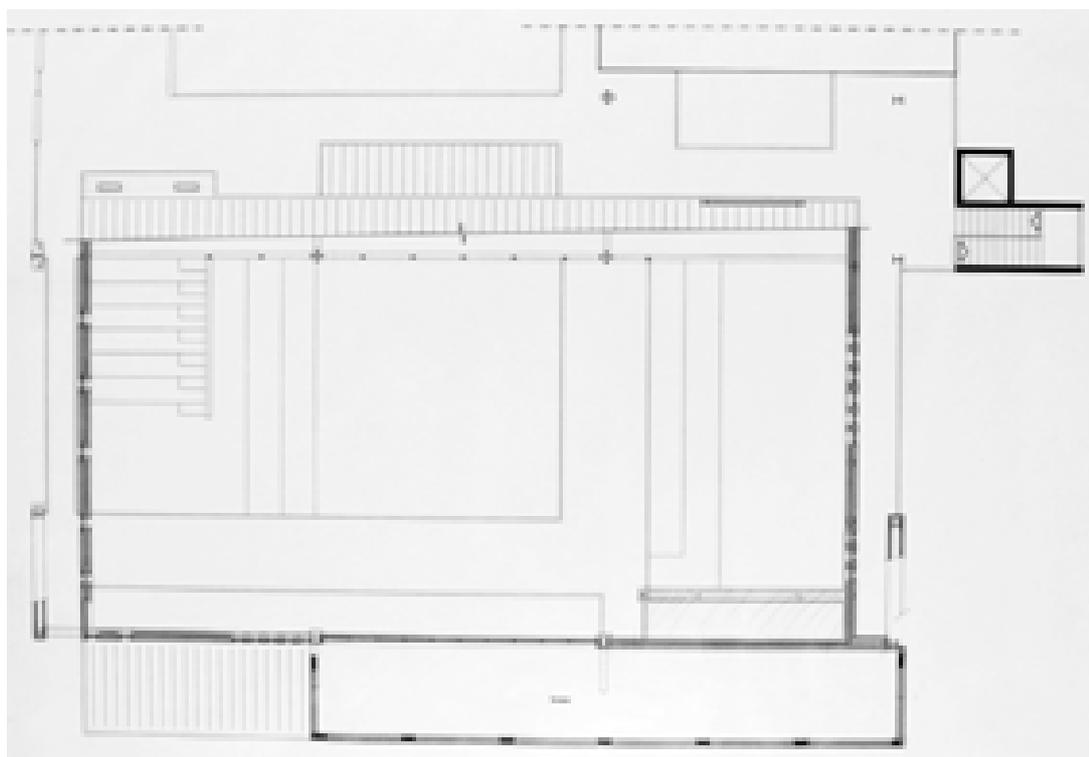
Pianta esecutivo piano terzo –01/07/1996 (AABS-1996.945)
